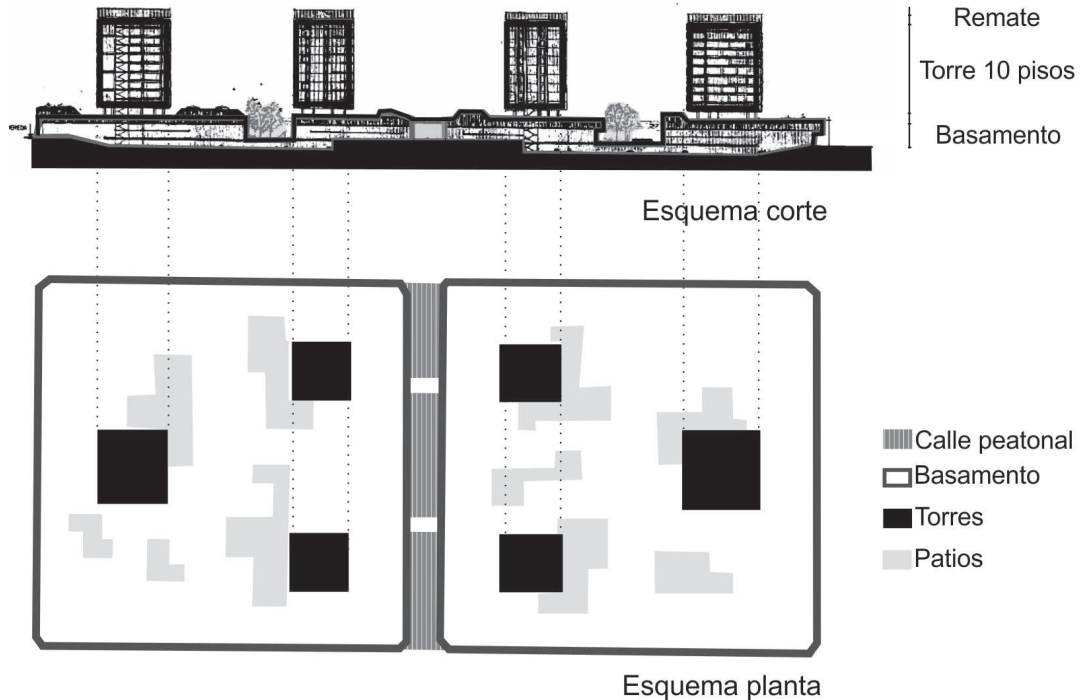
Planta y corte esquemáticos del área con mayor densificación. Fuente. Adaptado de CFI (1971).
